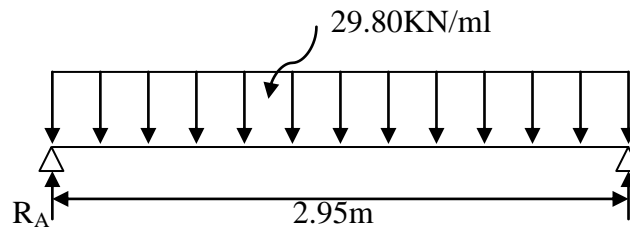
Schéma statique de la poutre palière l'ELS.
